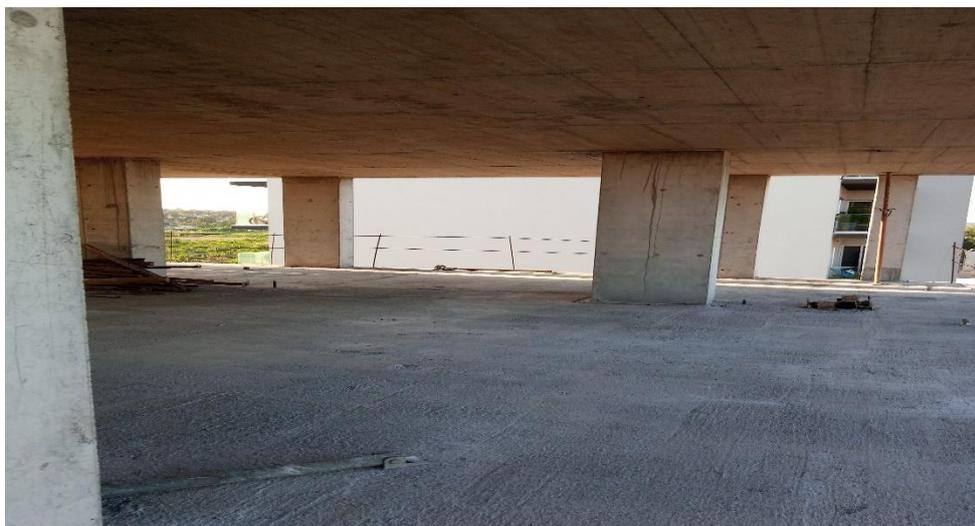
Laje fungiforme maciça de espessura constante(fonte-autor)
